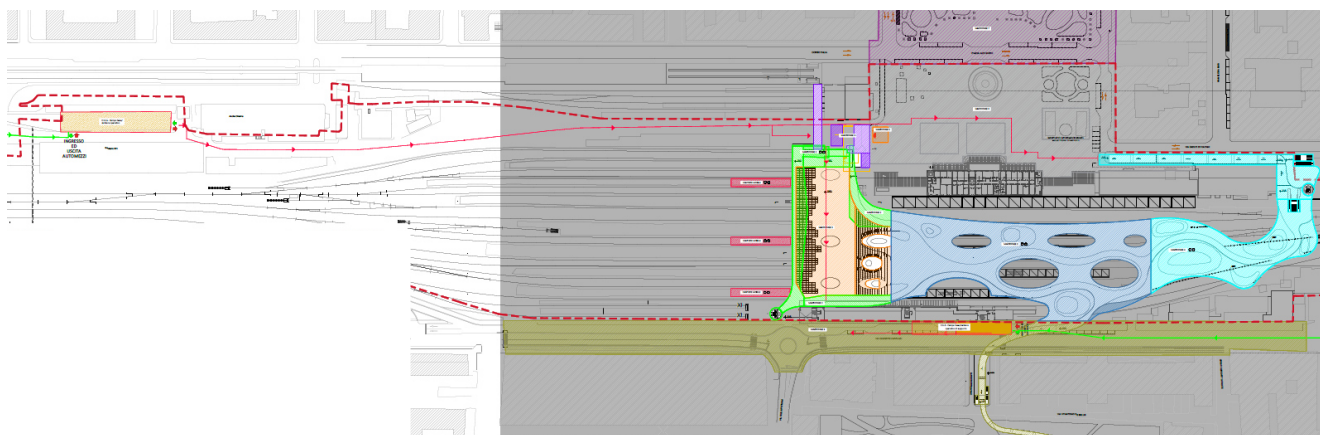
Planimetria delle macrofasi di realizzazione – piano copertura
